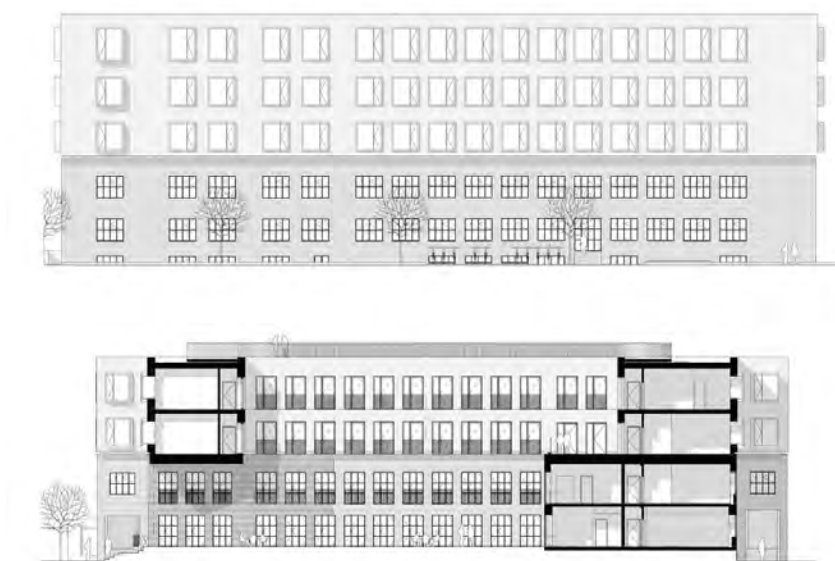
Проектні креслення Youth Dwellings: головний фасад із ритмічною сіткою віконних прорізів та поздовжній розріз будівлі [4]
